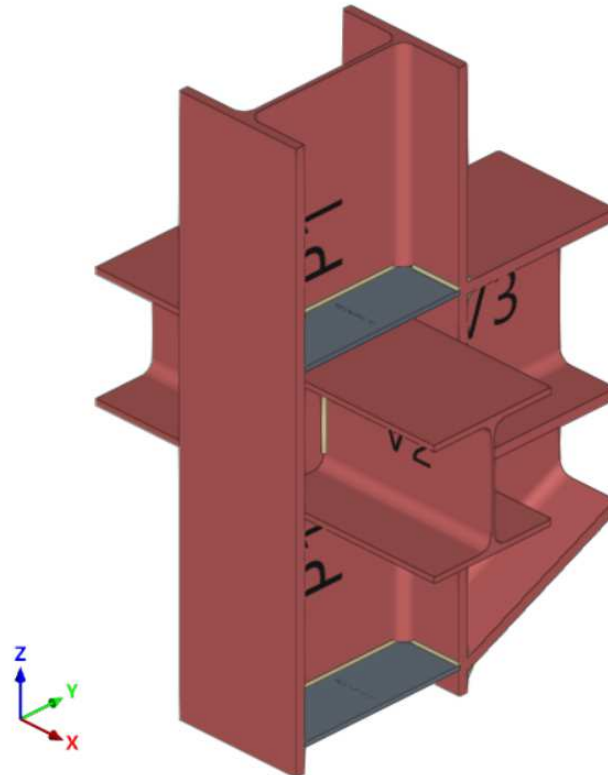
Unión Viga de carga-Viguetas-Pilar (Fuente propia)
